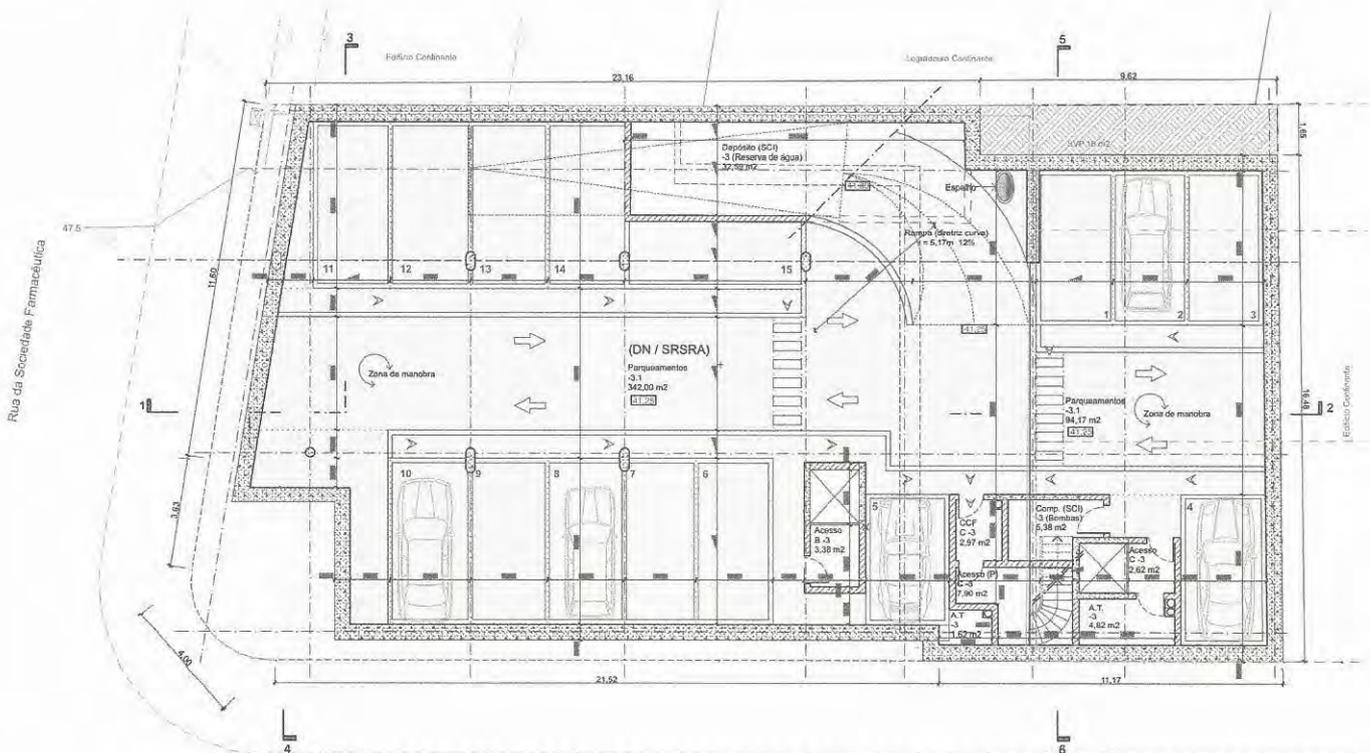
Planta da 3ª Cave de estacionamento – Dimensionamento da dotação de estacionamento
